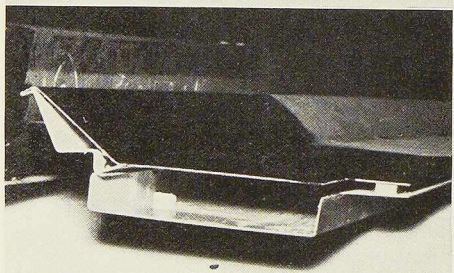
Fixation d'une poutre du toit et de la corniche sur une colonne extérieure.
